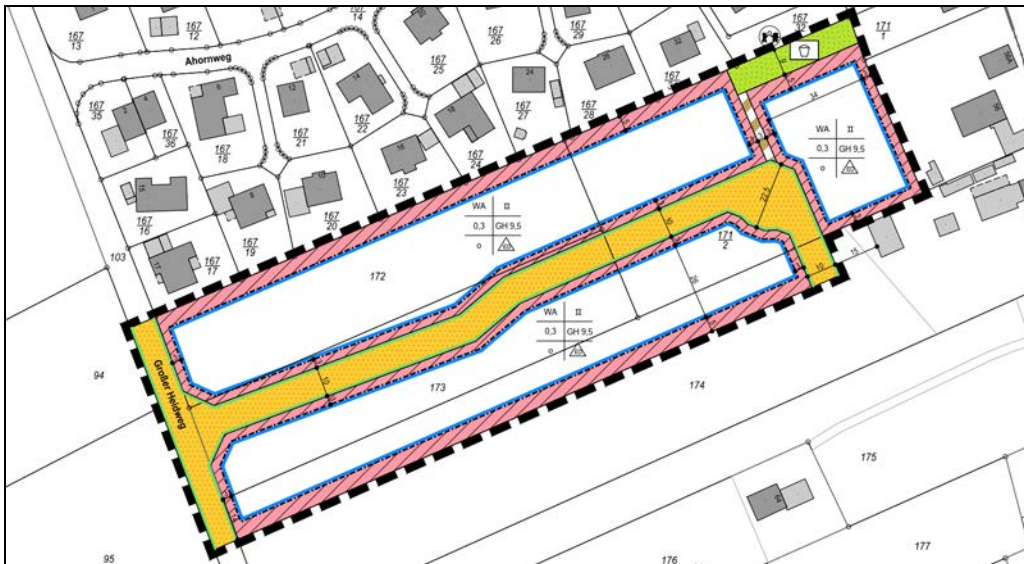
Bebauungsplan Nr.11 (ohne Maßstab)
